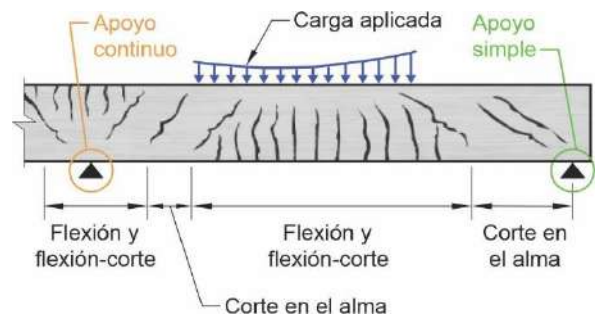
Tipos de fisuración en vigas de hormigón.
